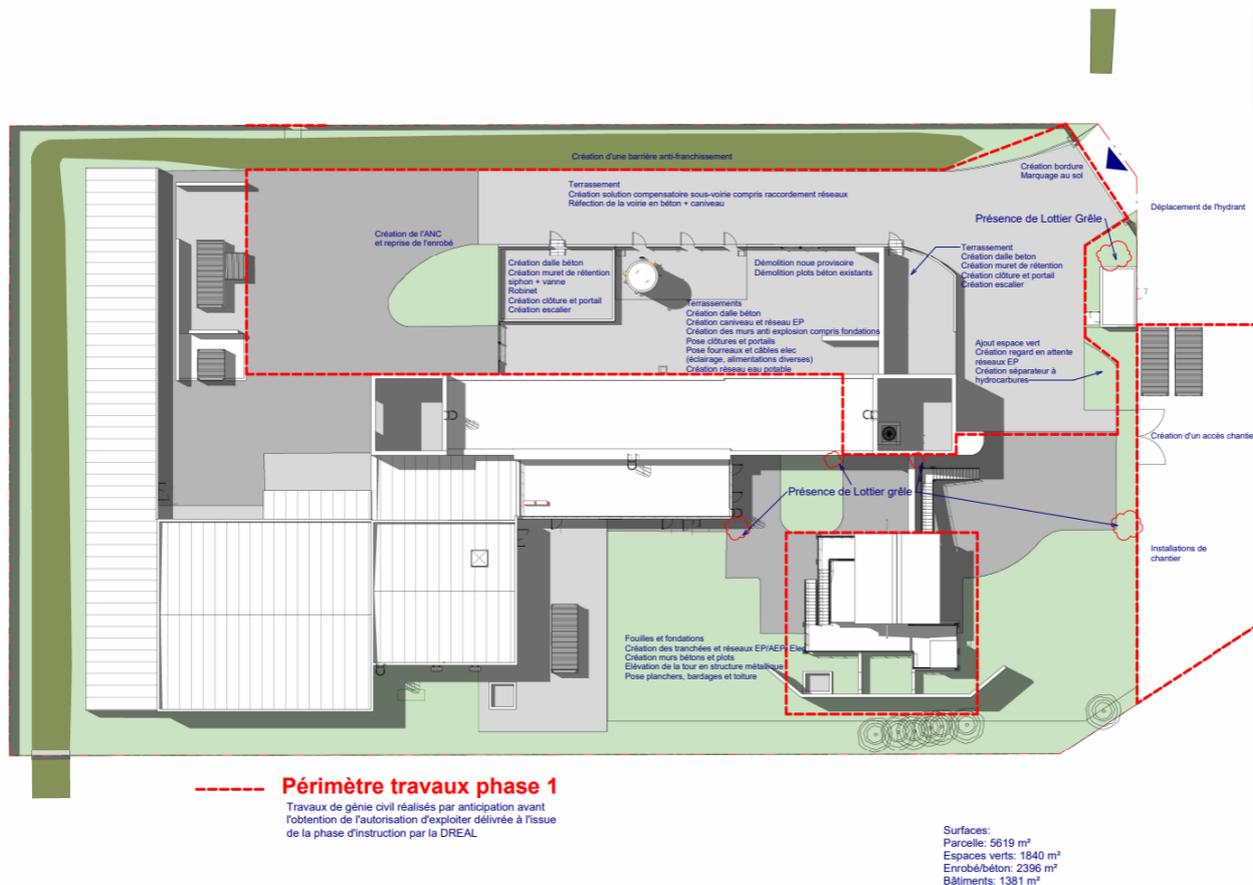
Plan de masse du zonage des travaux de la 1^{ère} phase (source : TVA Architectes)
